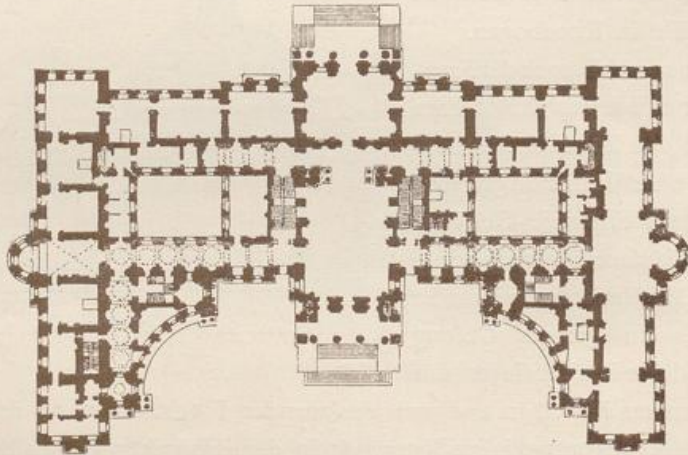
Grundriss von Schloss Blenheim (n. Fergusson).
